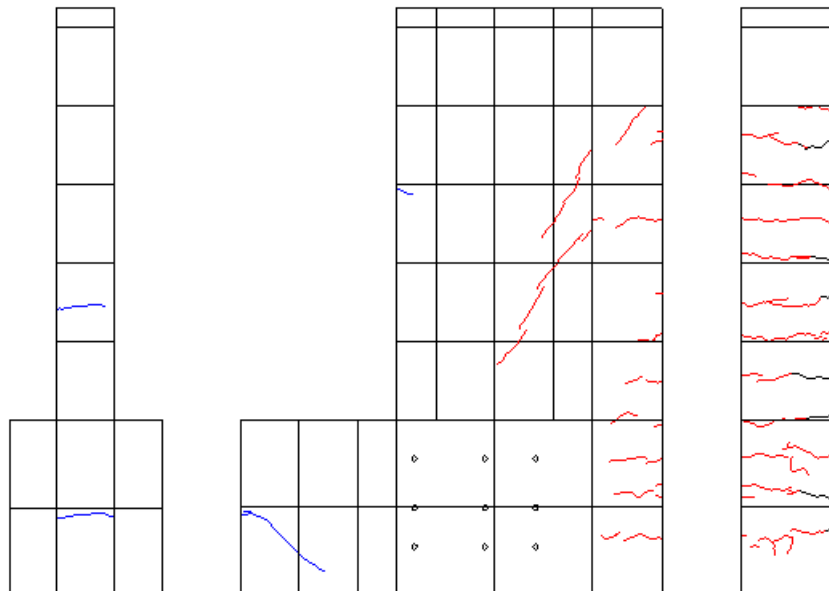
R=1/400②ひび割れ図
